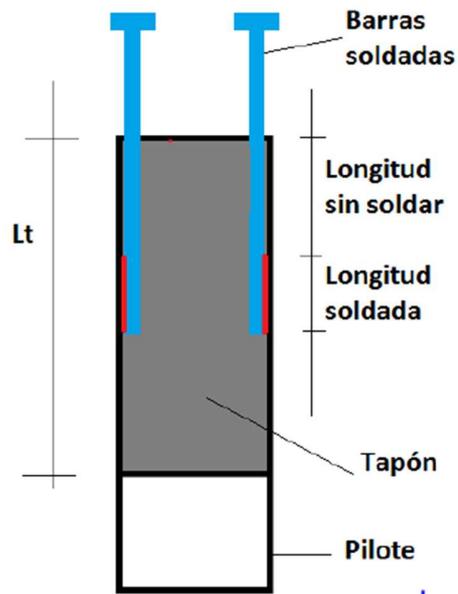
Esquema de barras soldadas en Interior pilotes
